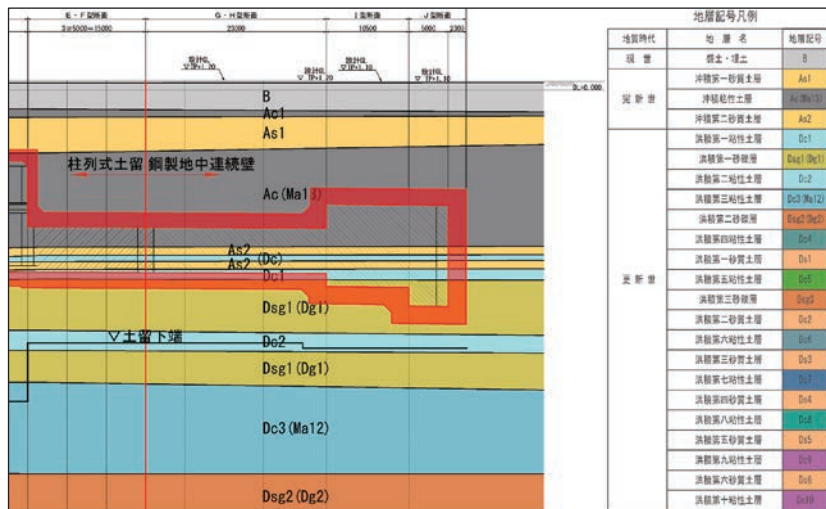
鋼製地中連続壁施工箇所付近の土質柱状図
